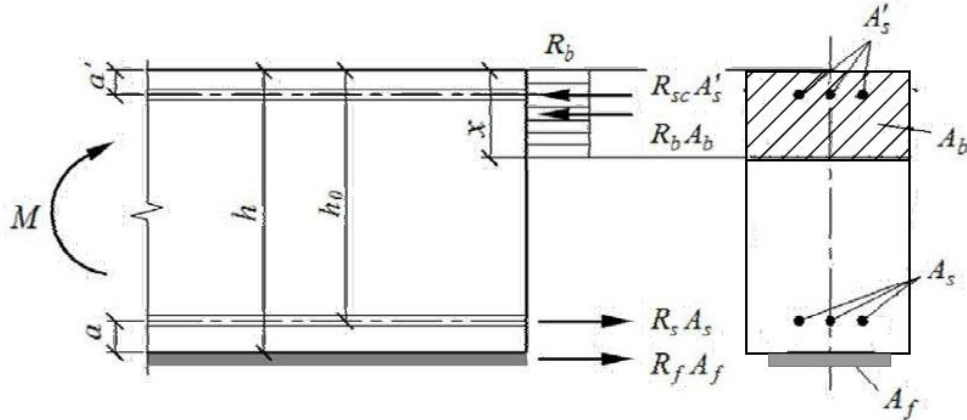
Схема усилий и эпюра напряжений в сечении, нормальном к продольной оси изгибаемого железобетонного элемента с внешним армированием из полимерных композитов, при его расчете по прочности
